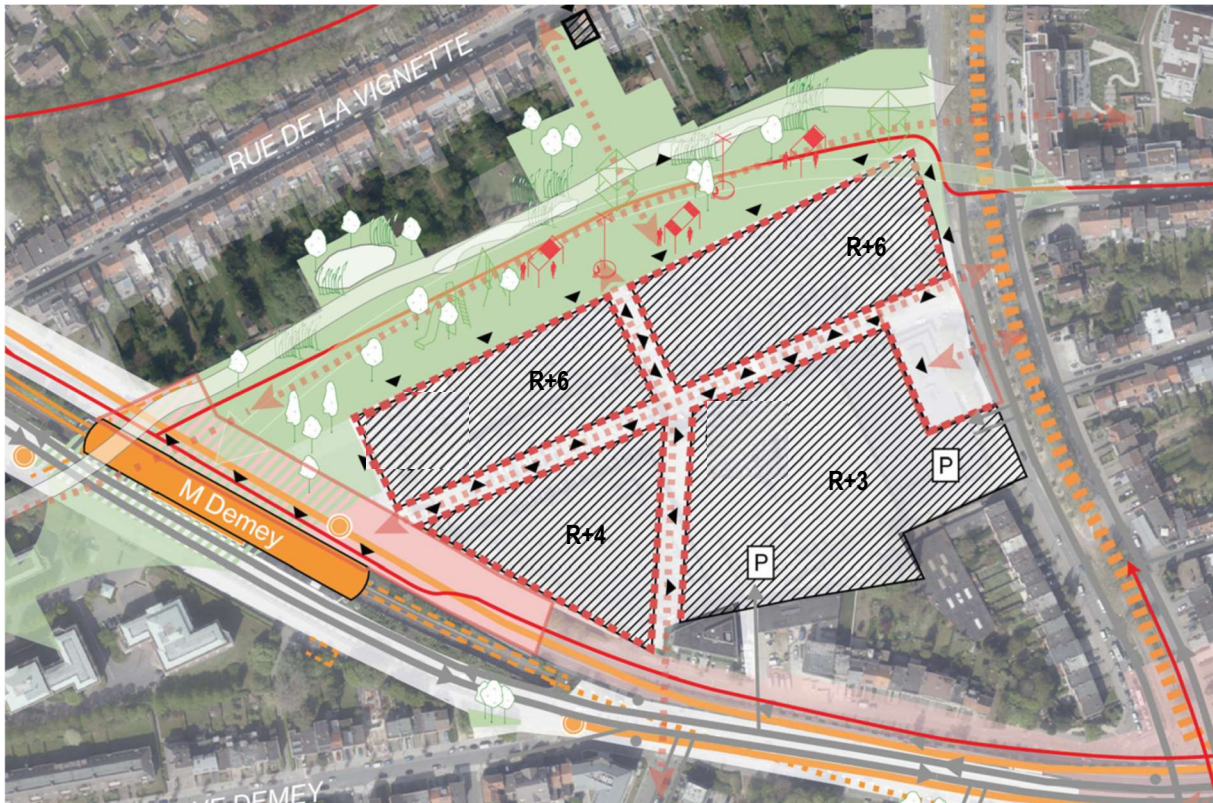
Plan d'implantation du site Demey (ORG², 2018)
